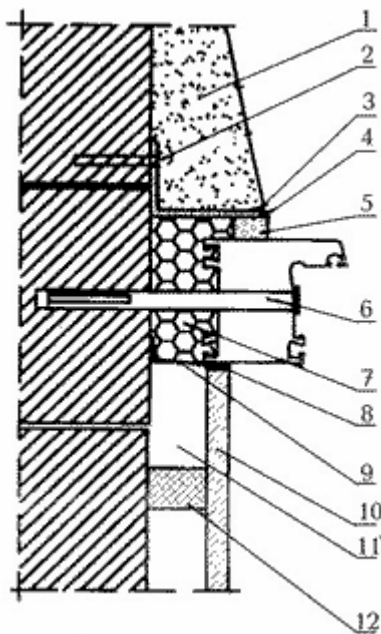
Узел бокового примыкания оконного блока к проему с четвертью в стене из кирпича, с отделкой внутреннего откоса штукатурным раствором
